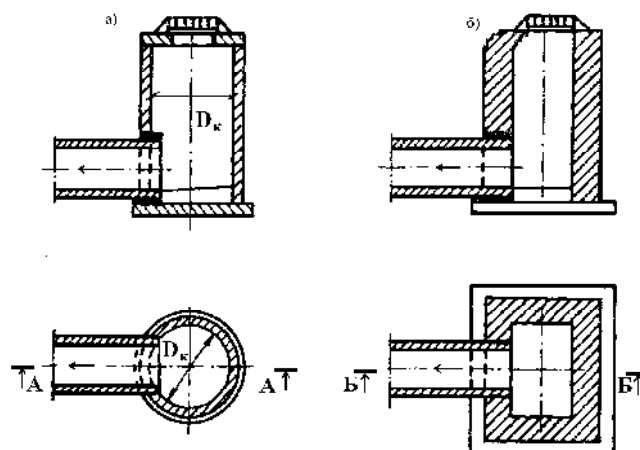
Дождеприемники: а - круглые, железобетонные; б - прямоугольные, кирпичные
